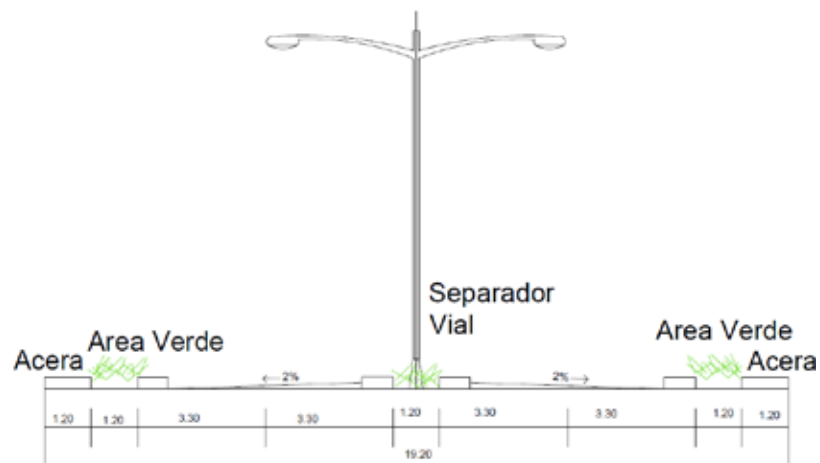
Perfil planteado de la Av. Augusto Malavé Villalba.
